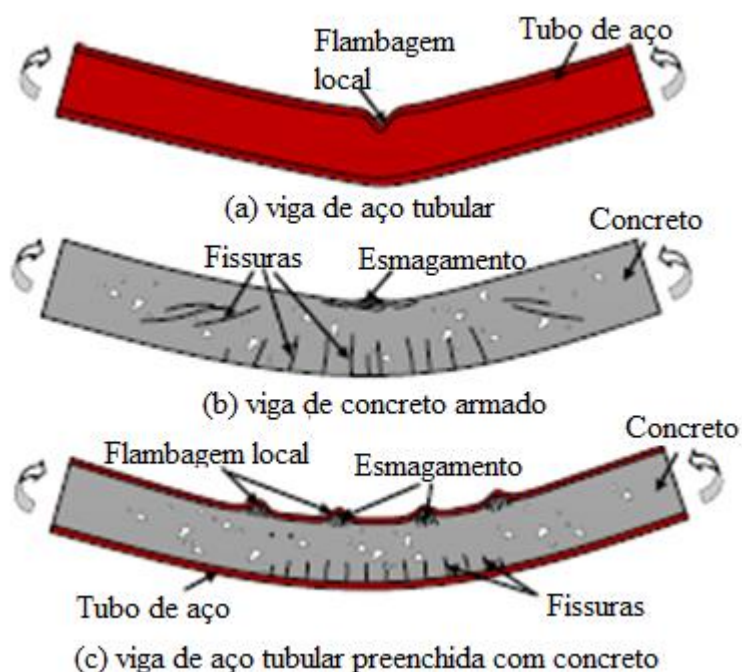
Comportamento a flexão tubo de aço (a), concreto (b) e tubo de aço preenchido com concreto (c). Fonte: HAN et al., 2014.
